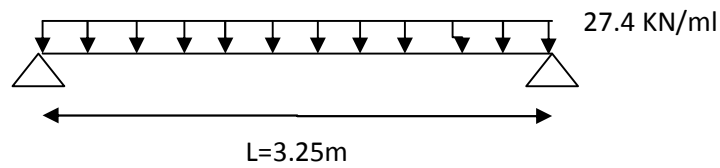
Schéma statique de la poutre palière à l'ELU
